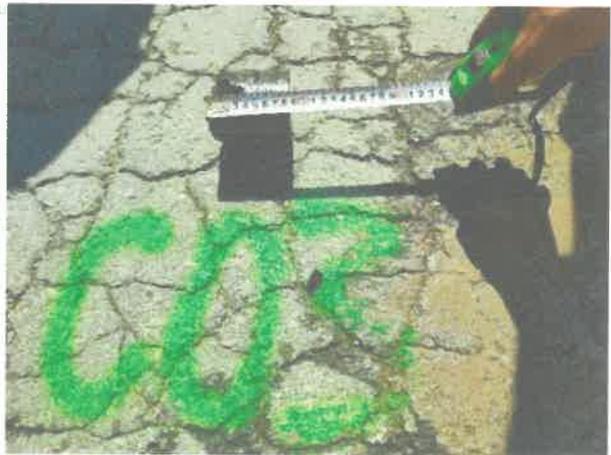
Execuție carote în mixtura asfaltică sau rigolă betonată
